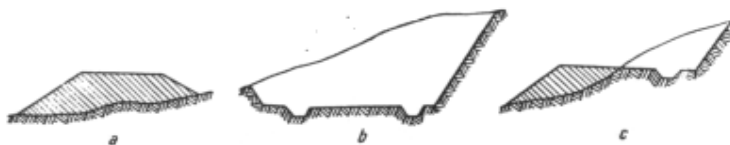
Tipuri de profile transversale: a – rambleu; b – debleu; c – mixt.
